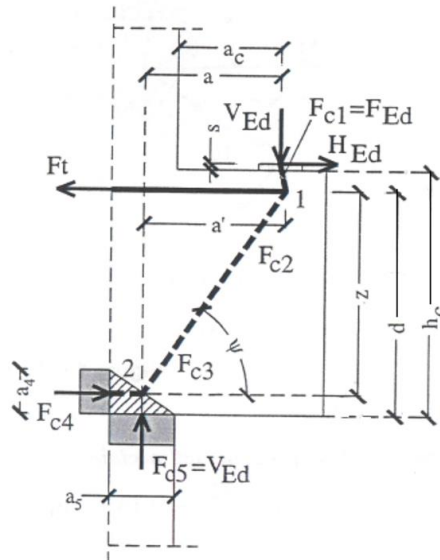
Schema di calcolo della forza di trazione nell'armatura principale
